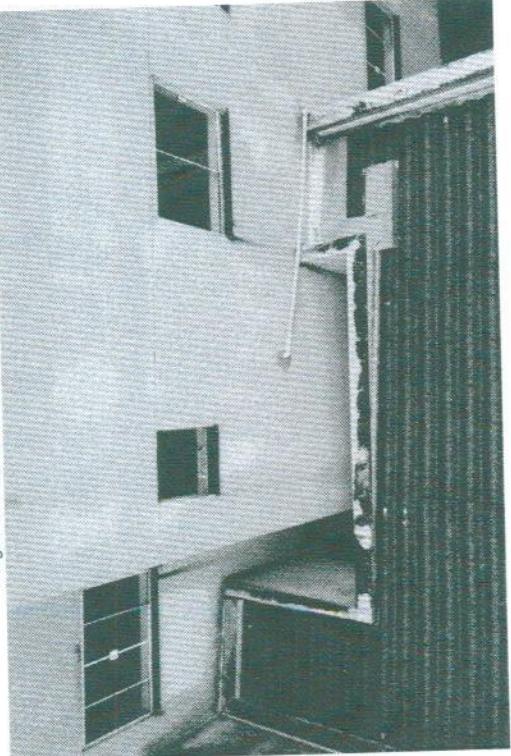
Biodeterioração da pintura e fissuras (fundos – Sul)
